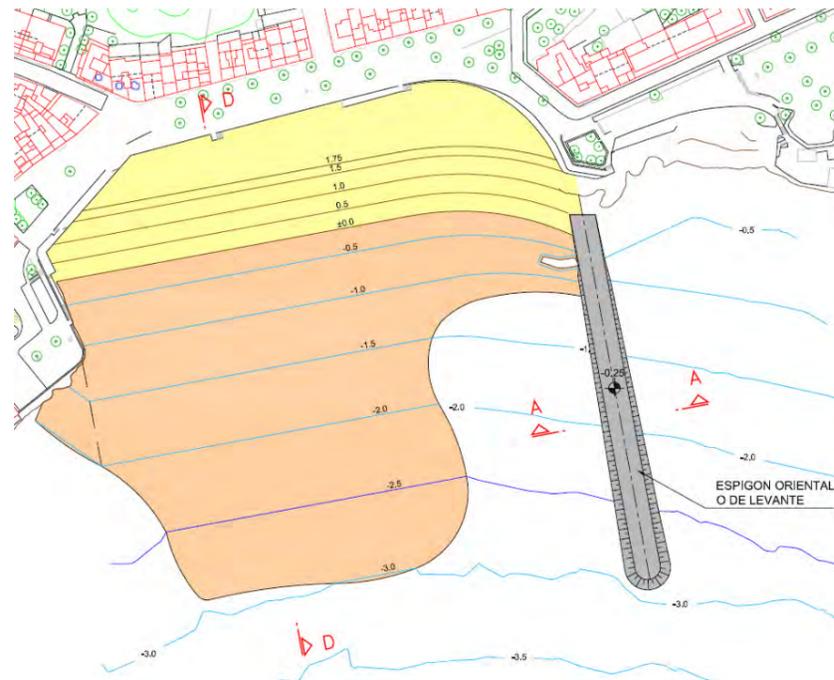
Planta de la Solución Base de la Alternativa 5. (Fuente: Elaboración propia)
